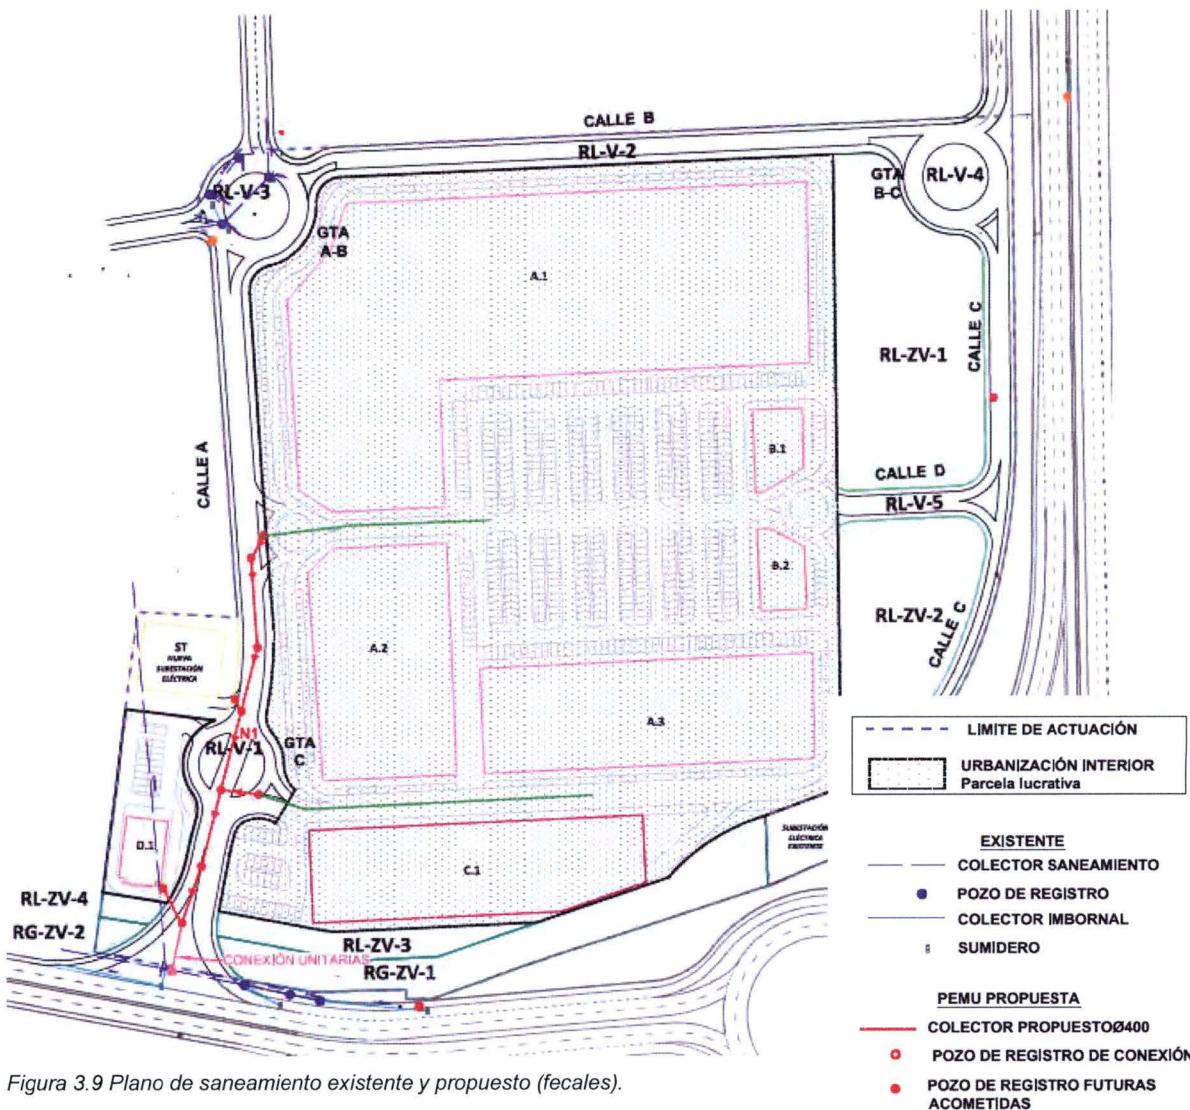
Plano de saneamiento existente y propuesto (fecales).
